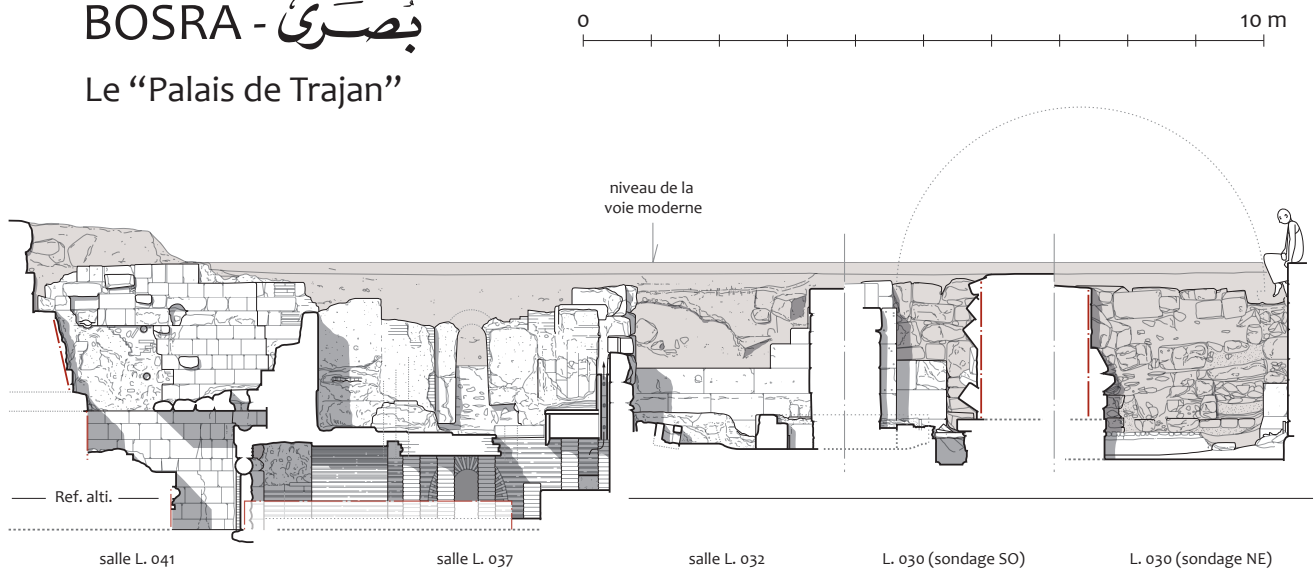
Le «Palais de Trajan», coupe 7, coupe-élévation nord-sud, vers l'ouest, sur les salles 41, 37, 32 et 30 des bains (1/100^e)
